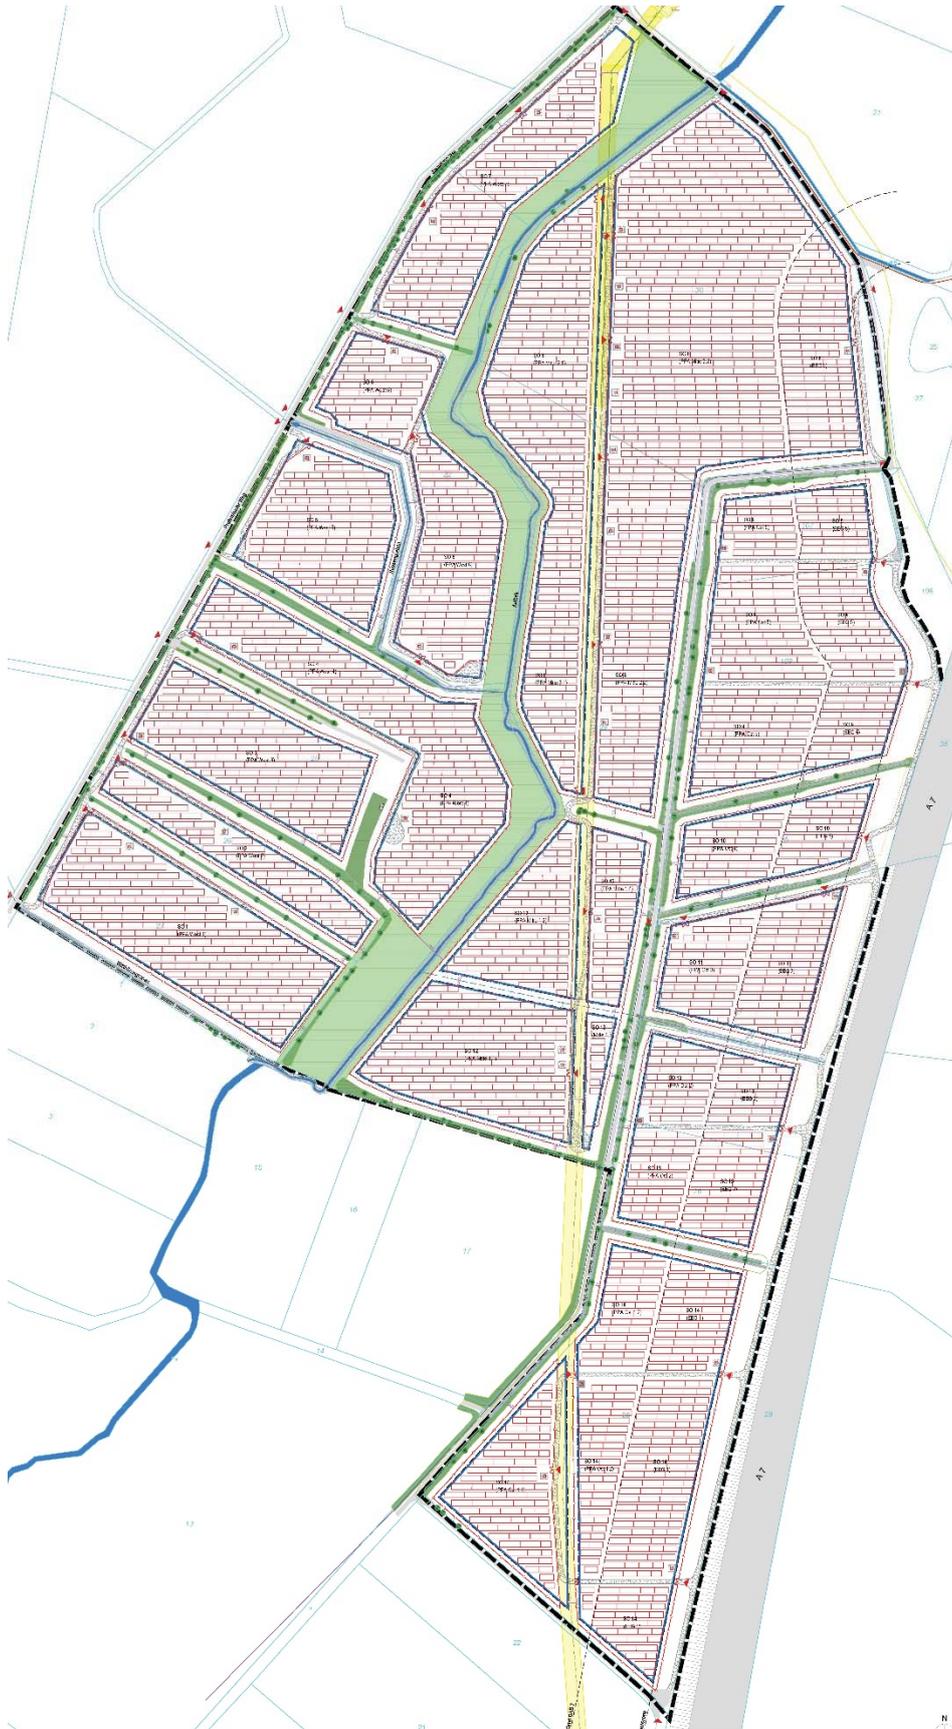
Ausschnitt aus dem Lageplan, Stand Mai 2020, ohne Maßstab. Der Plan ist unverbindlich, es gelten die Festsetzungen des B-Plans (Quelle: klm Architekten Leipzig GmbH)
